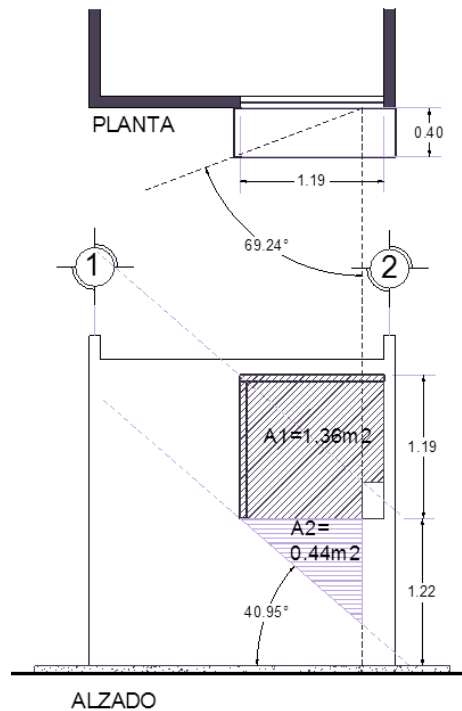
Proyección de sombras en planta (arriba) y alzado (abajo).
